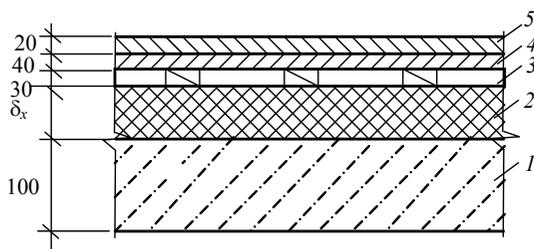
Вариант 2-й конструкции перекрытия над неотапливаемым подвалом:
